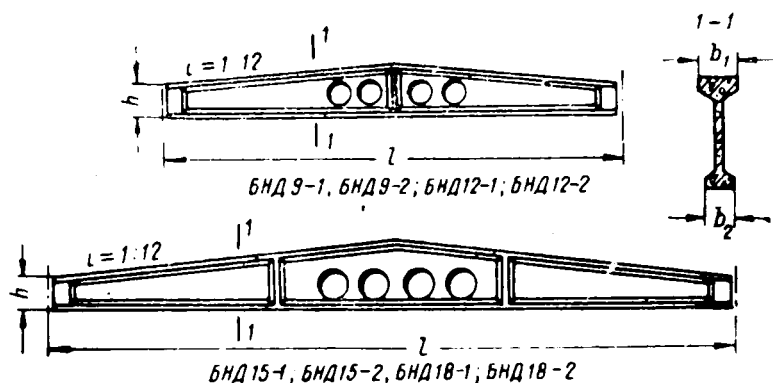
Первые типовые предварительно напряженные балки с проволочной арматурой
